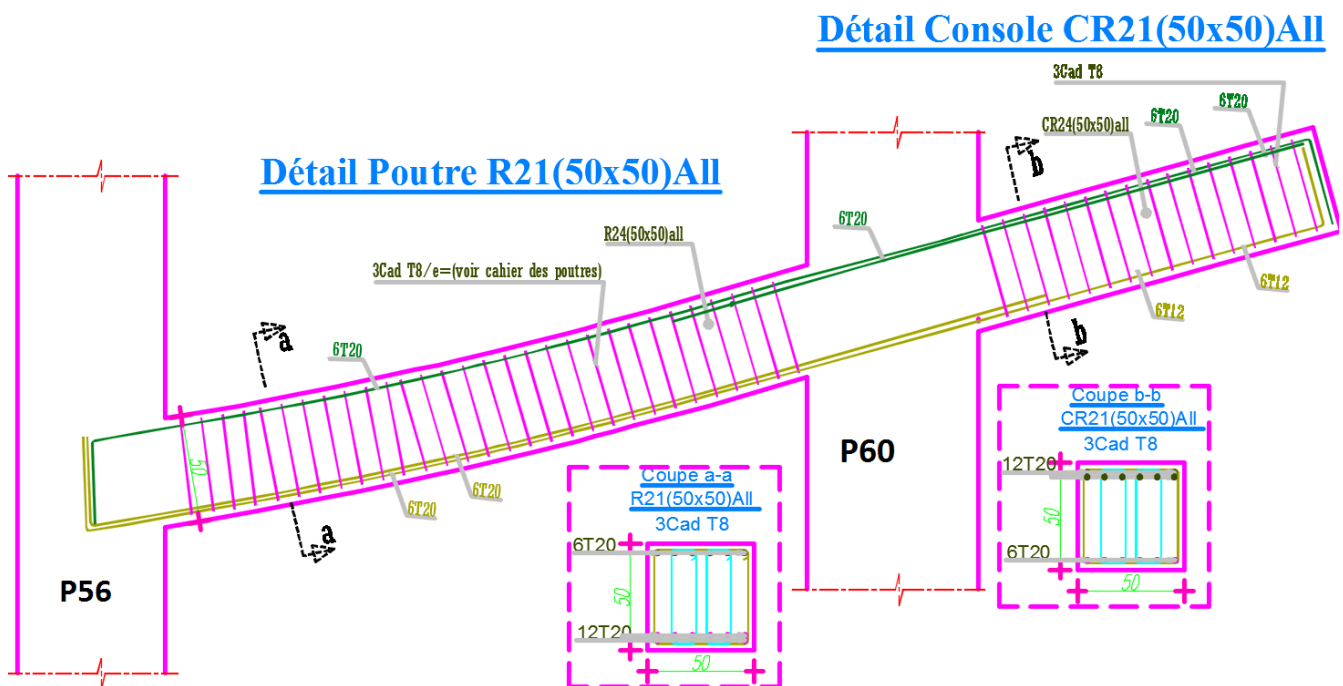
Détail de ferrailage de la poutre R21+ CR21
